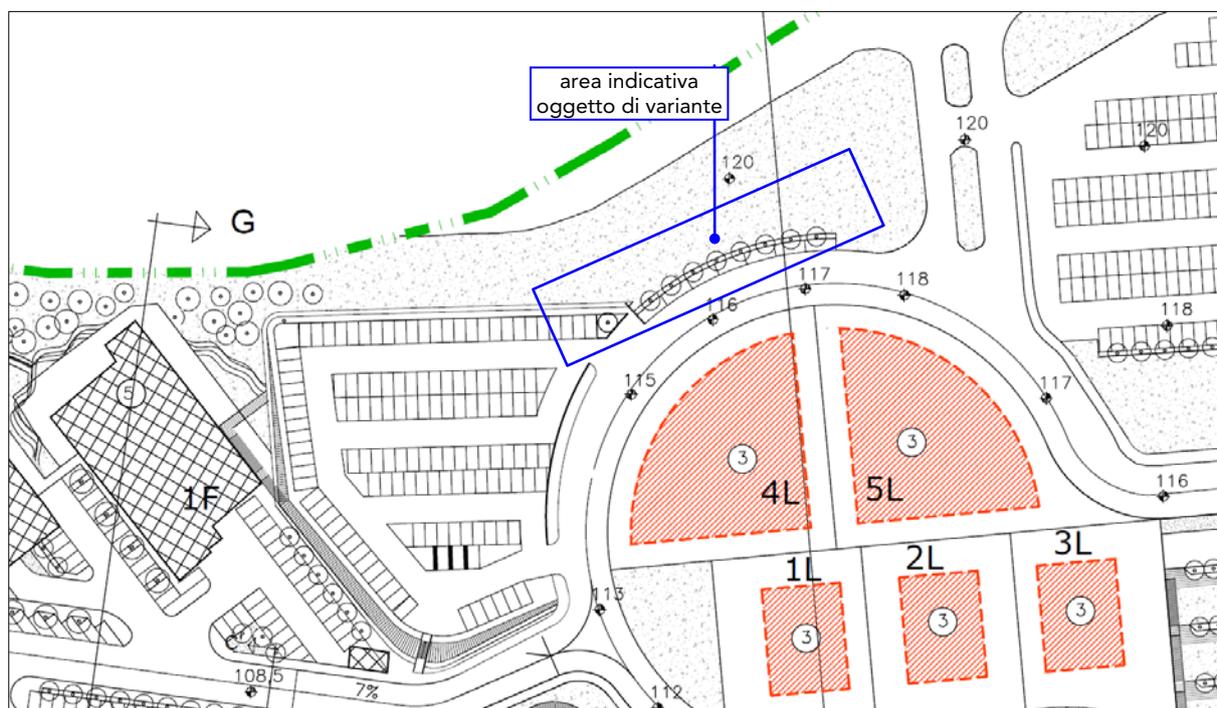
Estratto della Tavola 6 "Planimetria generale di progetto" della variante di completamento del PP Zona D2 approvata con DGC n. 83/2021, con indicazione dell'area oggetto della presente variante.
